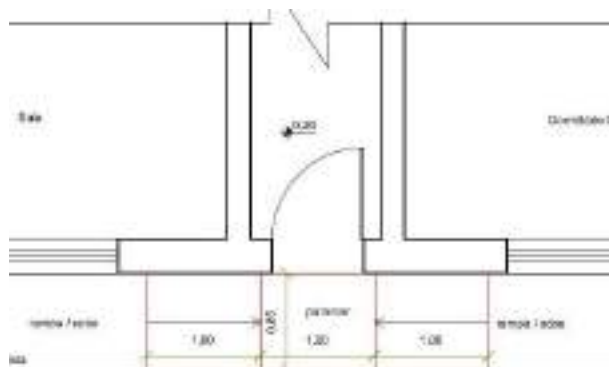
Croqui da planta-baixa com a localização das rampas e patamar a serem construídos.
